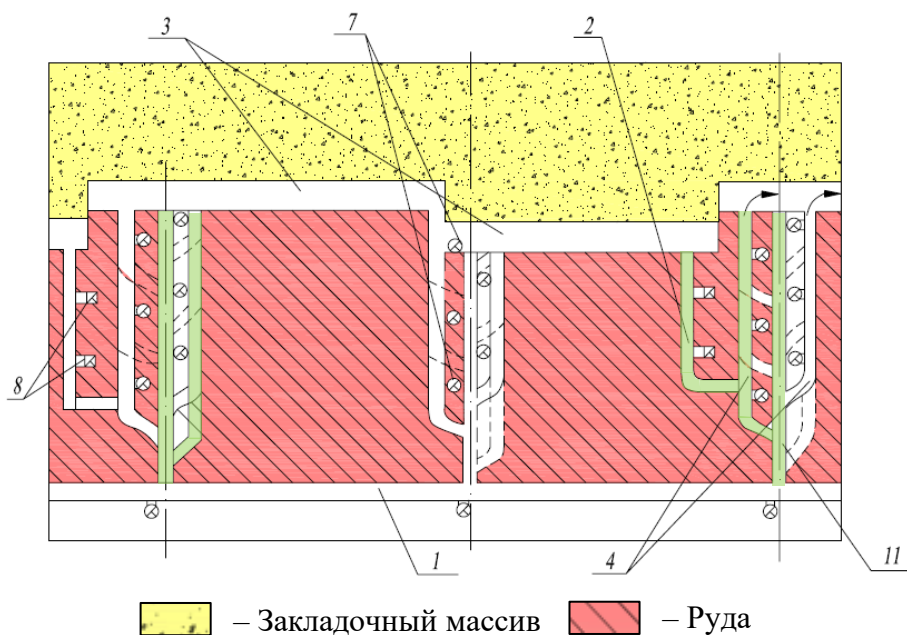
Схема подготовки панелей фланговыми уклонами (поперечный разрез): 1 – фланговый уклон; 2 – слоевые орты; 3 – очистные забои (слои); 4 – рудоспуски; 5 – вентиляционные восстающие; 6 – откаточный горизонт
